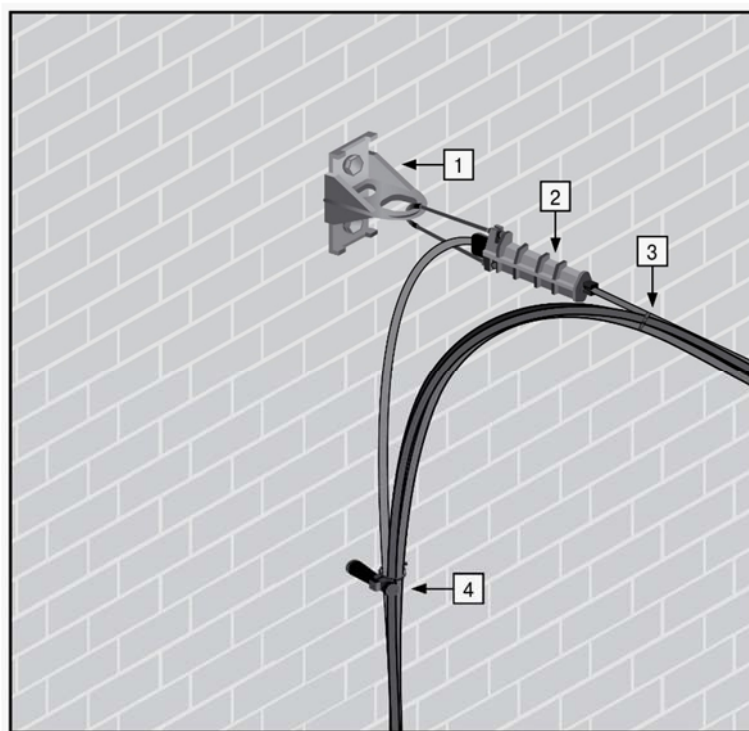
Анкерное крепление магистральной линии СИП к стене здания
